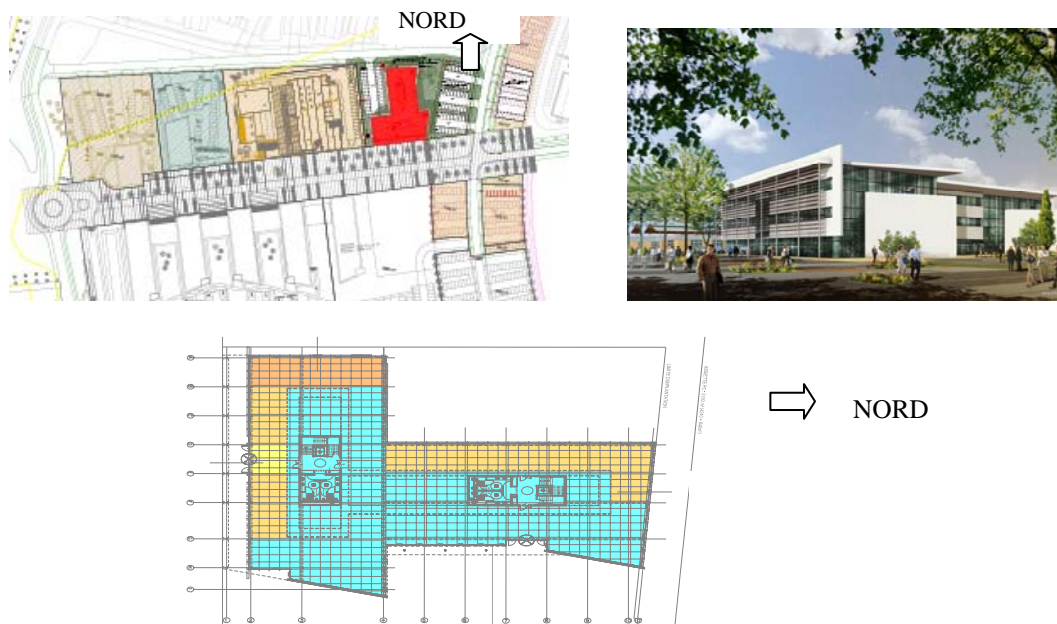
En haut plan masse du site et perspective du bâtiment. En bas plan schématique d'un niveau du bâtiment (architecture : DEGW Espace Architecture).
